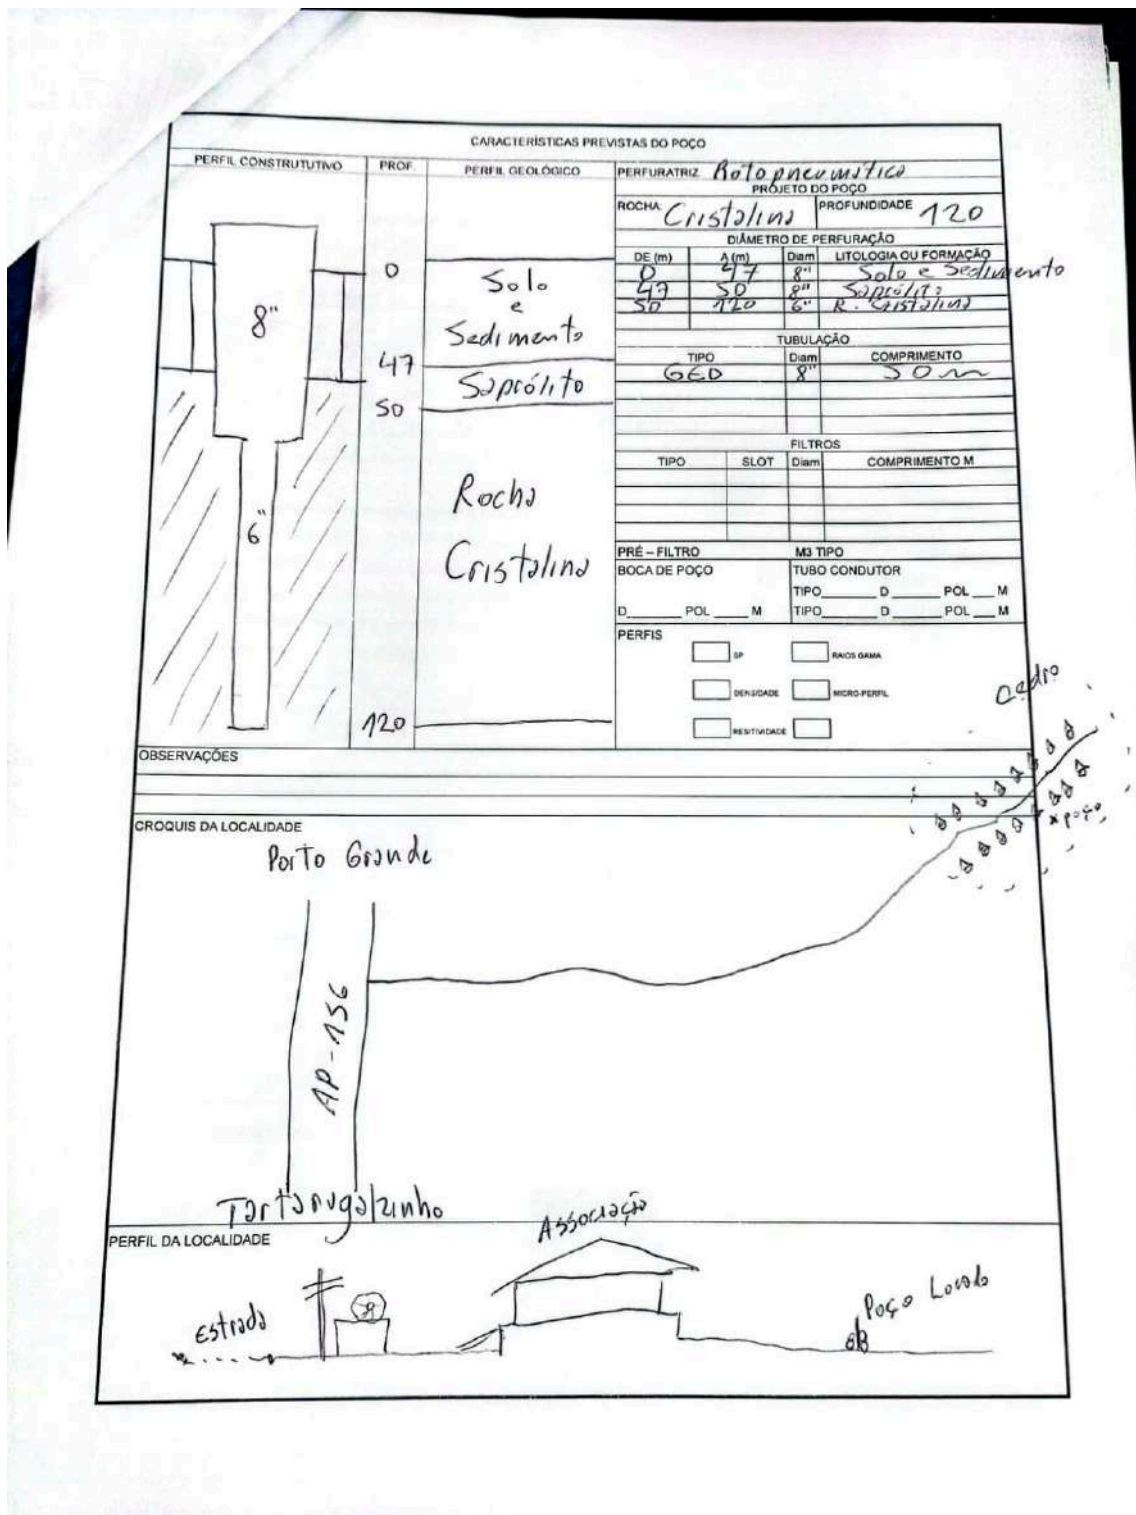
Ficha de locação de perfil construtivo do poço. Parte 3/3.
